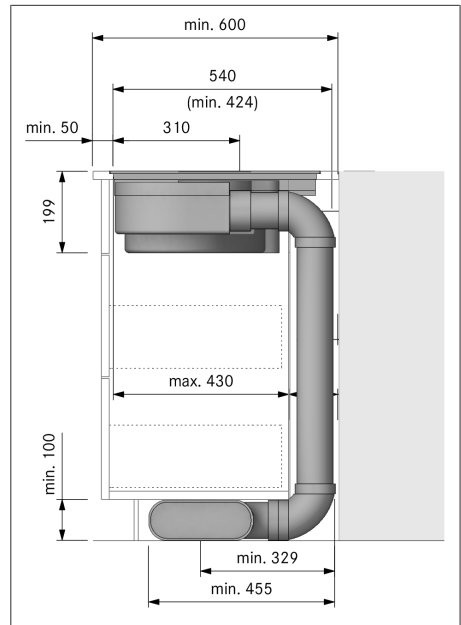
Monteringsdimensjoner ved uttrekking, benkeplatedybde 600 mm
